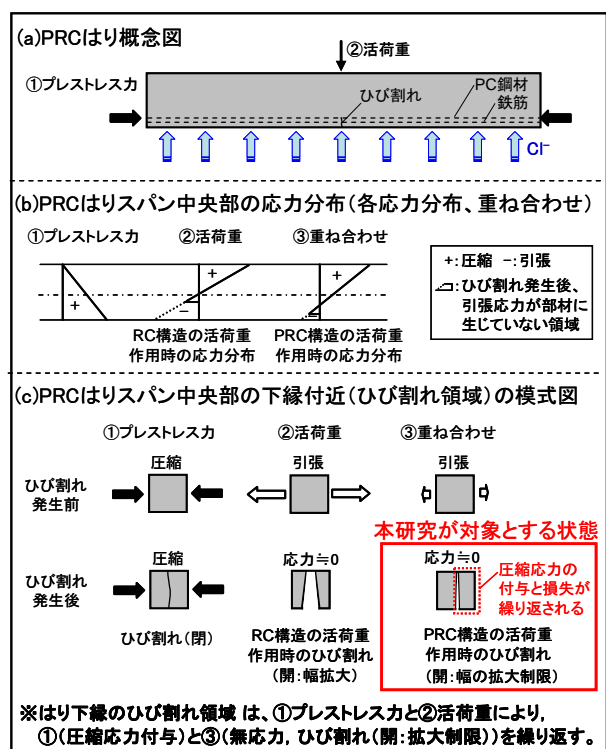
本研究が対象とする応力およびひび割れ状態
